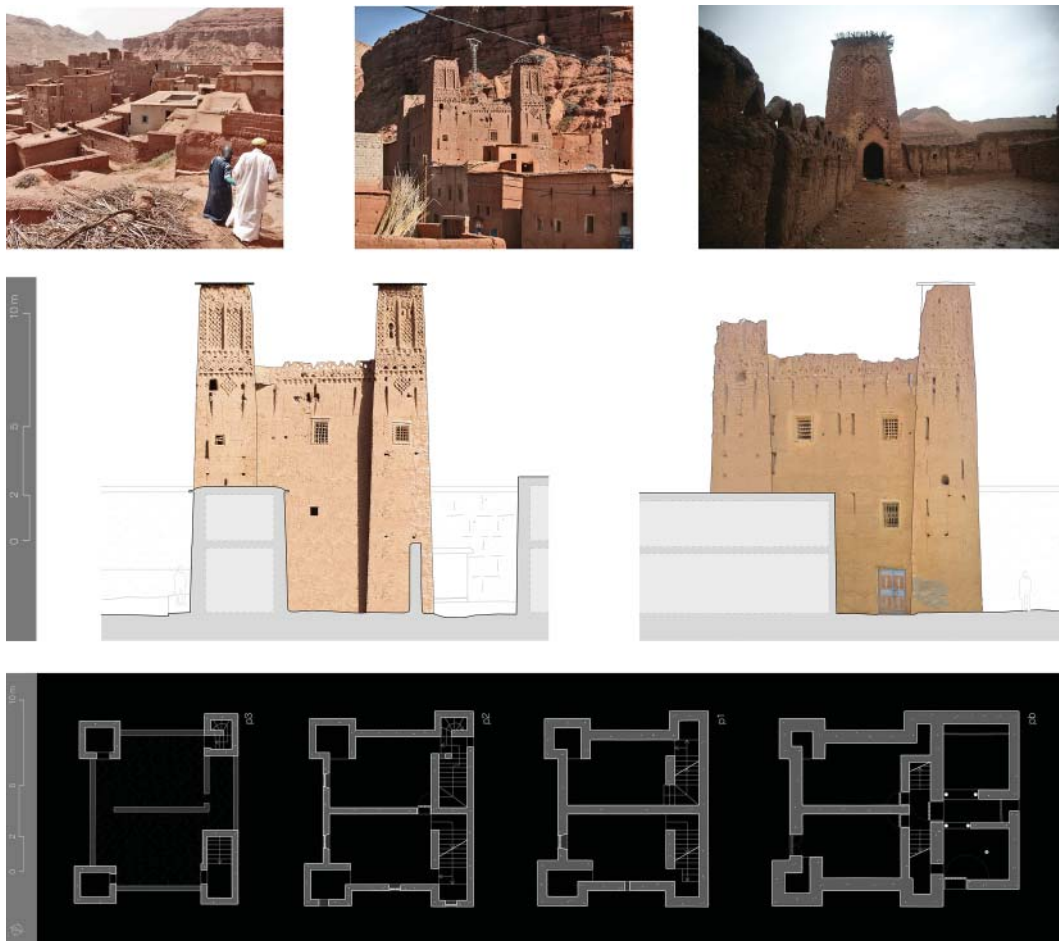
Kasbah Ait Aicha. Fotografías exterior y azotea. Alzados oeste y norte. Plantas. Fuente: Grupo UPV.
